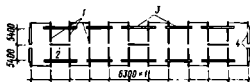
Крупнопанельный 17-этажный жилой дом с широким шагом поперечных стен. Конструктивная схема:
